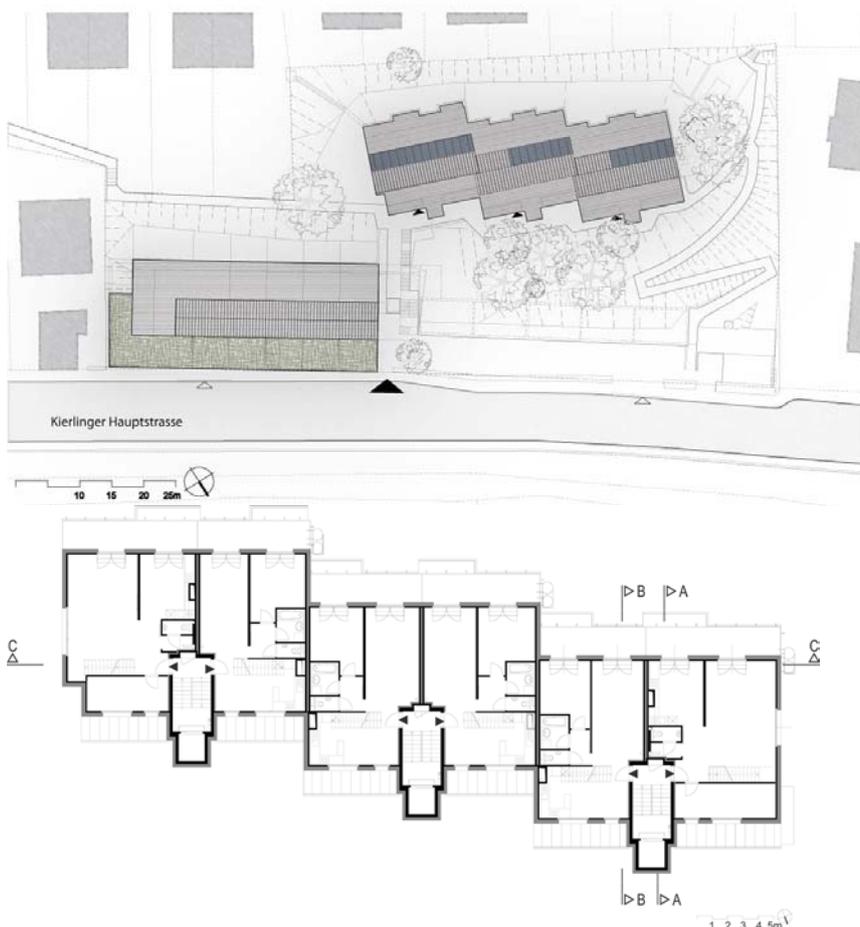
Lageplan der Wohnhausanlage Kierling; links - Neubau - rechts Bestand (oben) [75]
